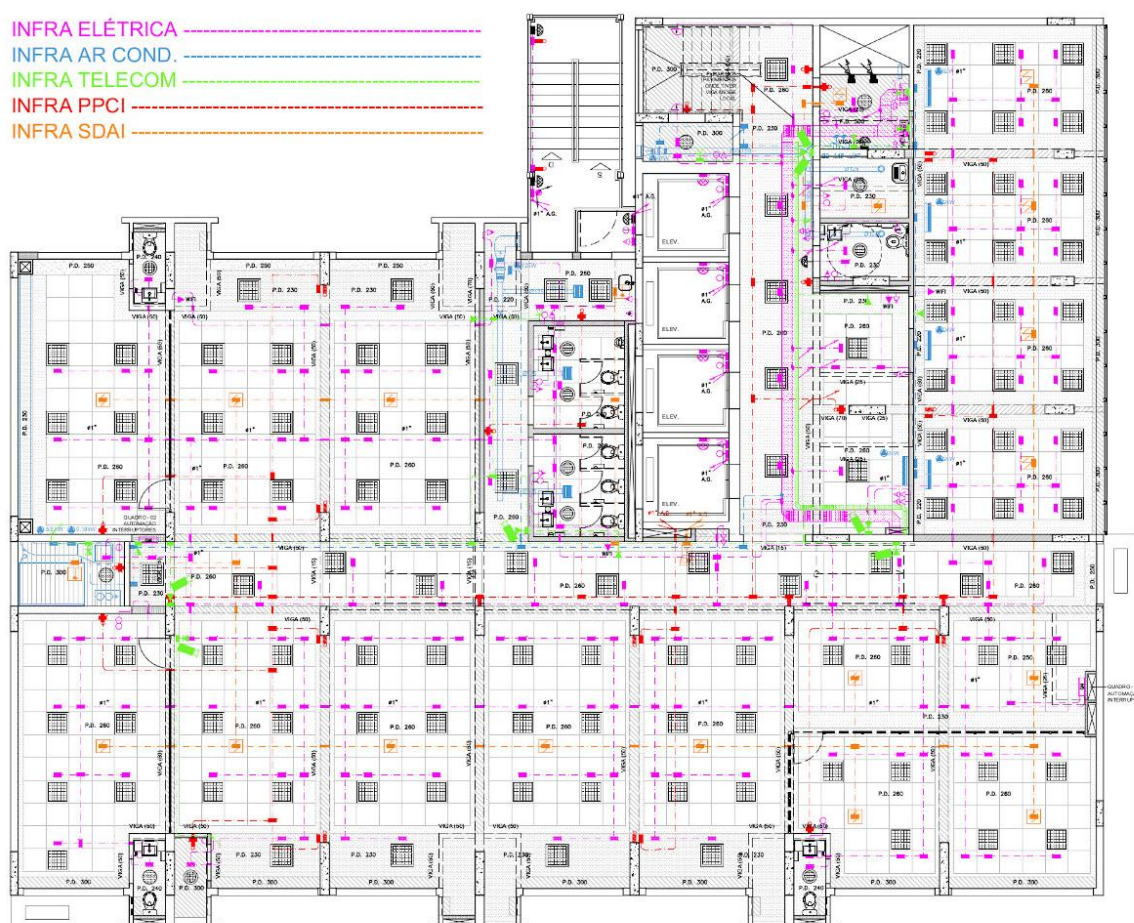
Projeto elétrico planta tipo B - 5º ao 13º pavimento e Detalhe de transposição de infraestrutura no piso do pavimento superior.
